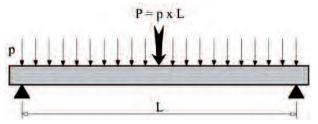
SOLLICITATION EN FLEXION D'UNE POUTRE SUR 2 APPUIS
